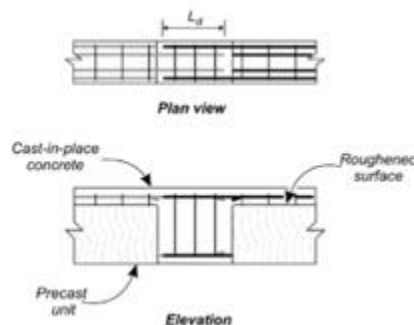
Conexión por traslapos en vigas (fib, 2003).
